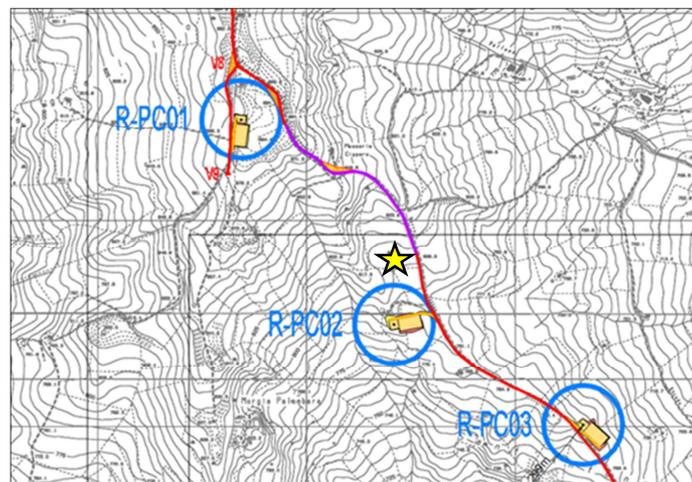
Area sud-ovest - Ubicazione area di cantiere ★
